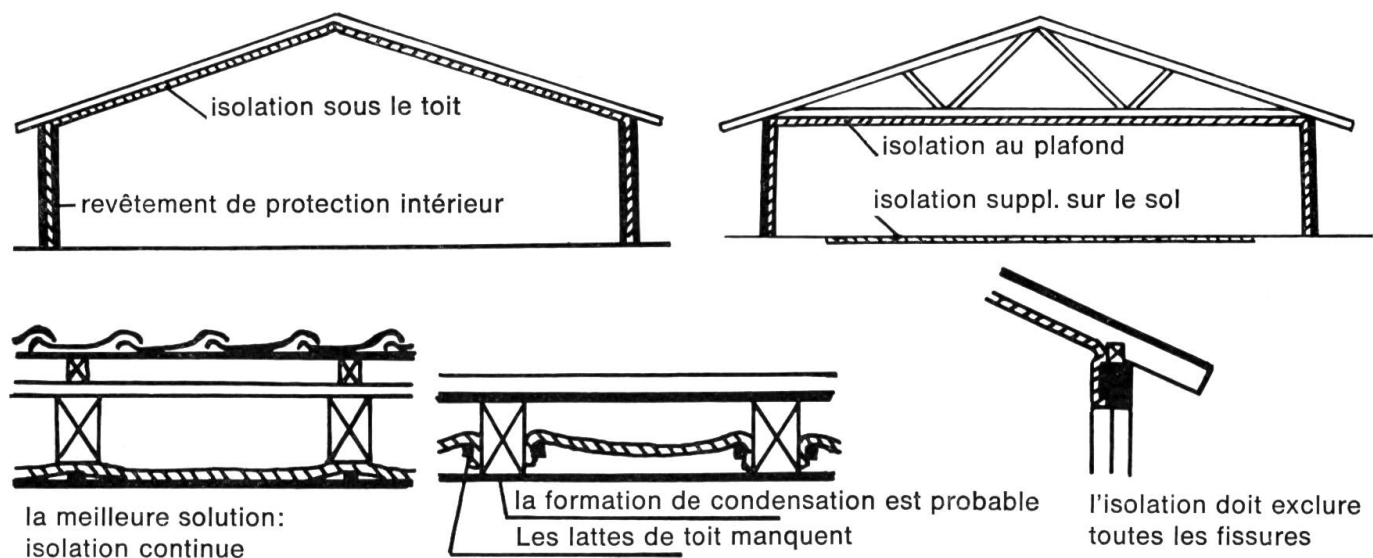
Exemples d'isolations permettant l'étanchéité des locaux.
